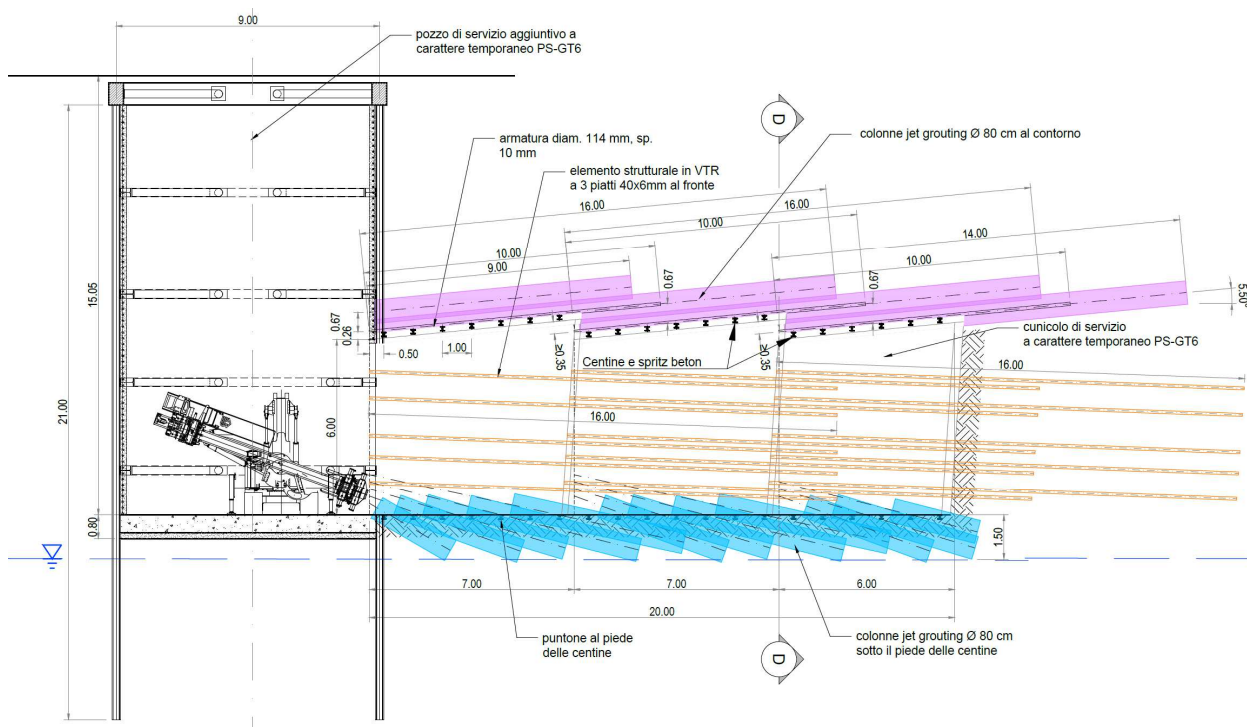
Trattamento jet grouting per il cunicolo PS-GT6: sezione longitudinale.
